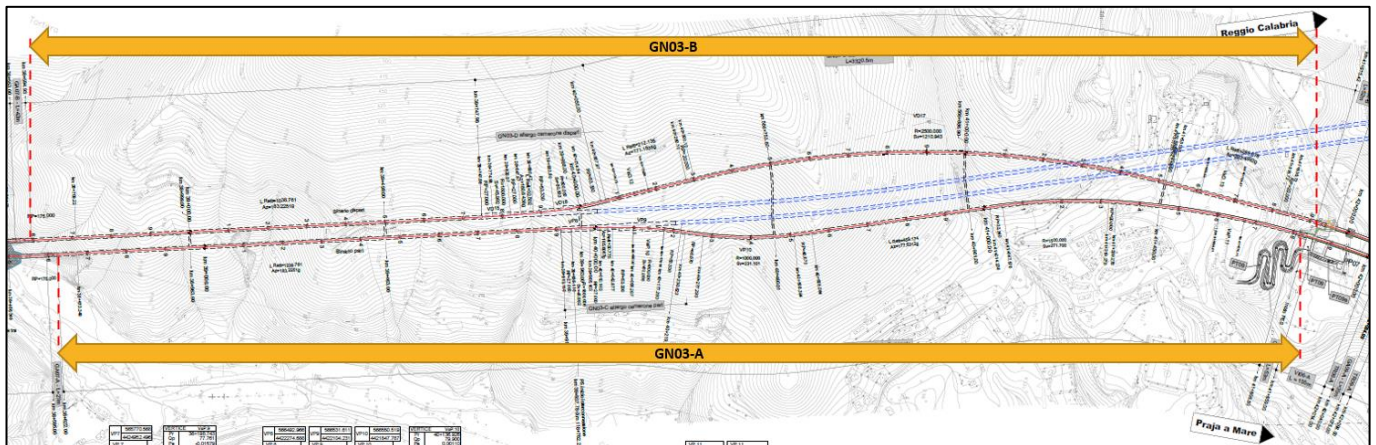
Planimetria di progetto gallerie GN03-A/B da km 38+595 al km 41+859 BP
